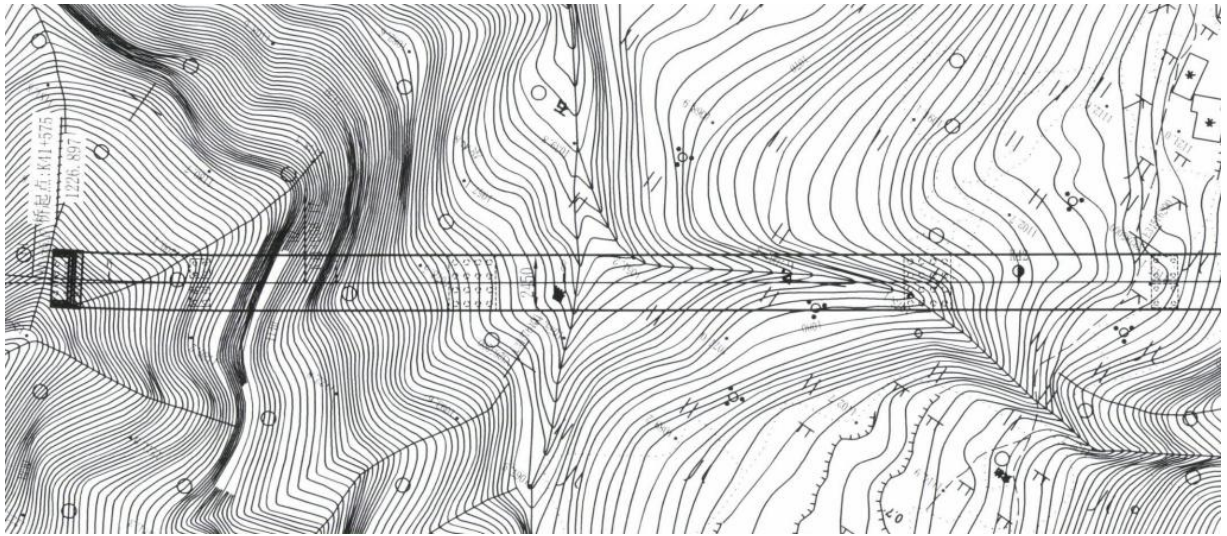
黑石沟特大桥主桥平面布置示意图 (尺寸单位为 cm, 桩号及高程单位为 m)
